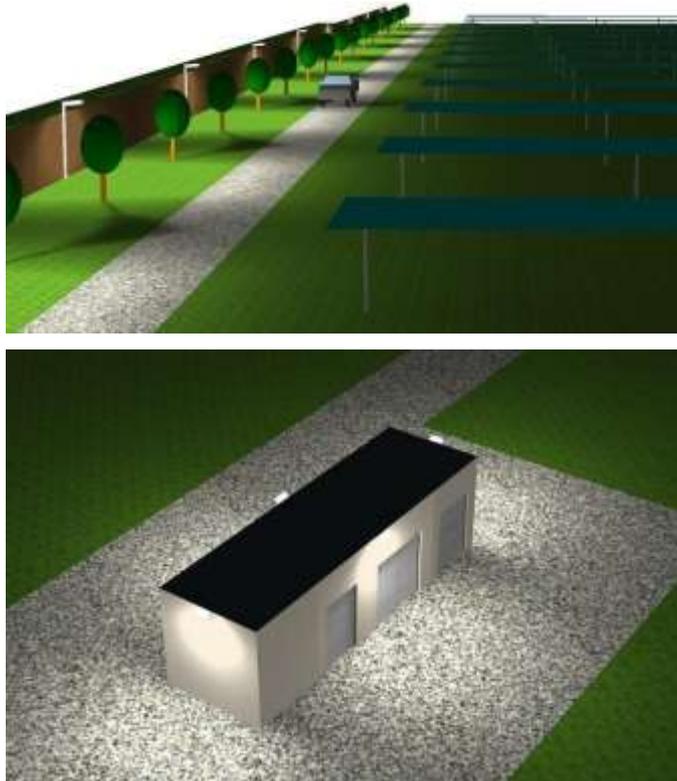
Rendering impianti luminosi installati (estratto elaborato FSPREL001)
